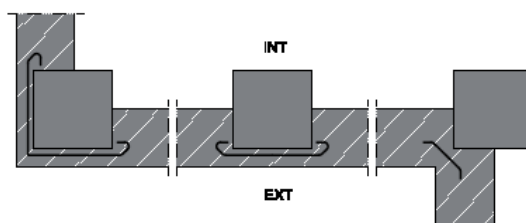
Ejemplo de encuentro de la fachada con los pilares
